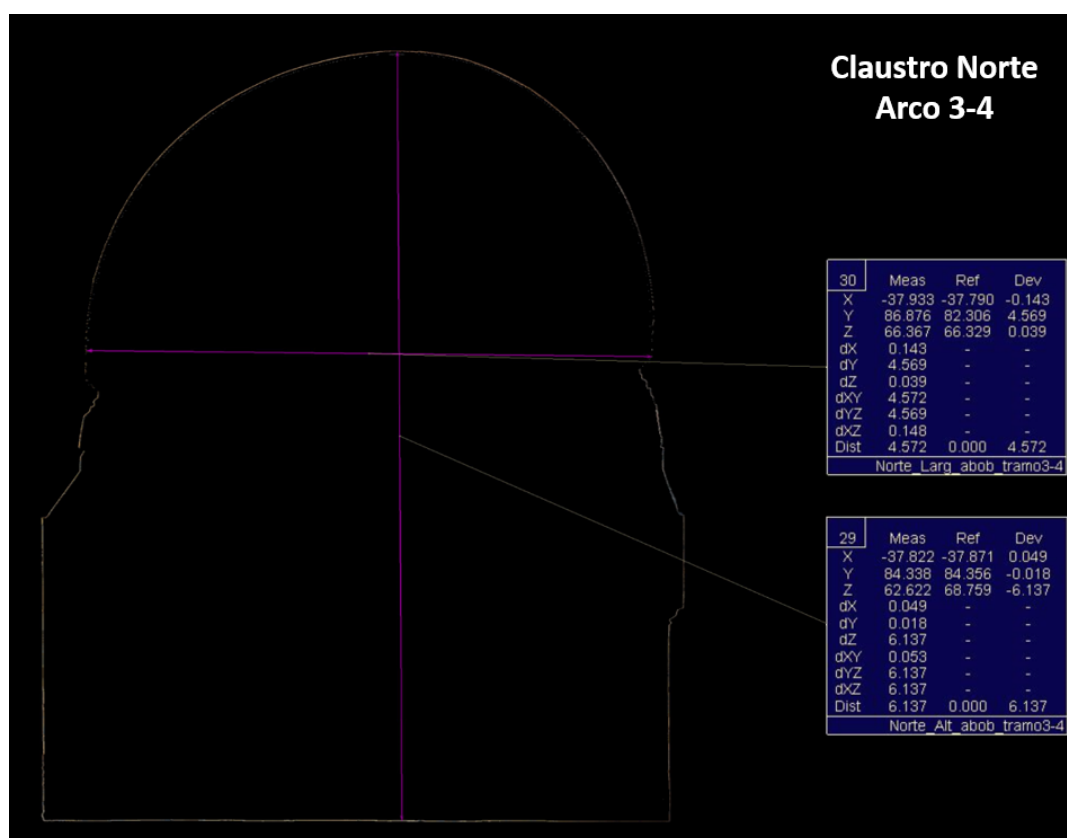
Corte transversal do Arco 3-4 do claustro Norte de D. Dinis.
